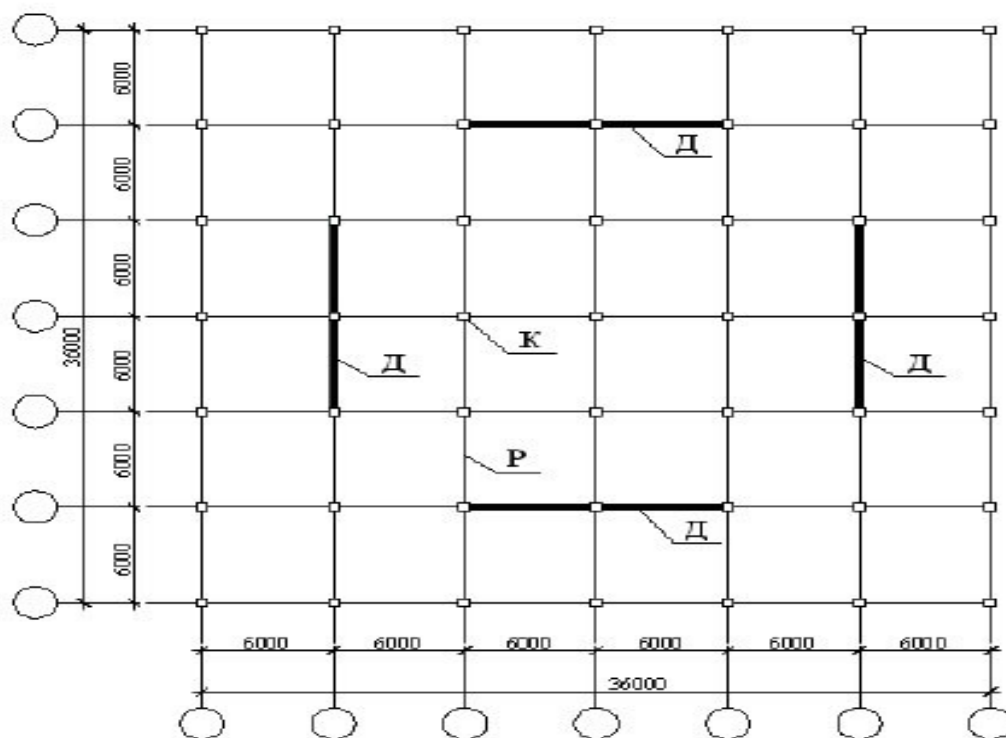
План типового этажа Д – железобетонные диафрагмы жесткости; Р – железобетонные ригели; К – колонны
